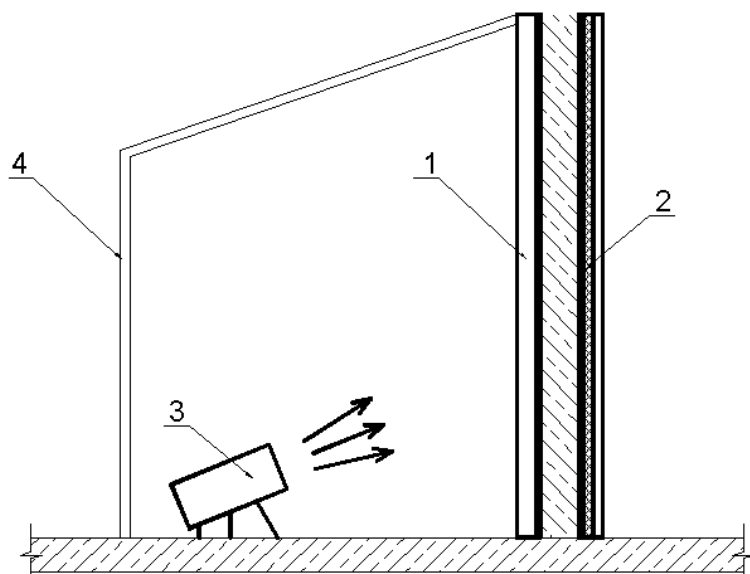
Обогрев конструкции стен. 1 – неутеплённая опалубка стен; 2 – утеплённая опалубка стен; 3 – тепловентилятор; 4 - конструкция тепляка (закрытая брезентом).
